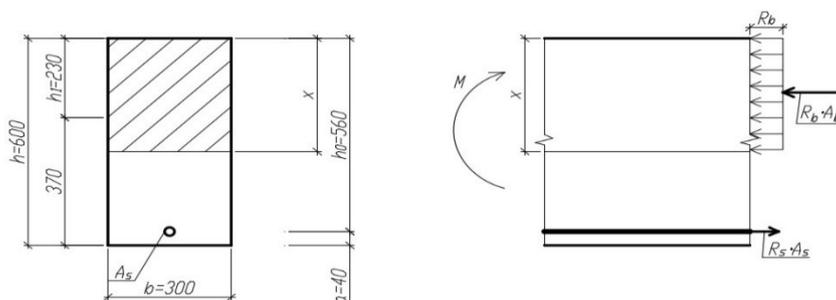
Поперечное прямоугольное сечение изгибаемого железобетонного элемента
